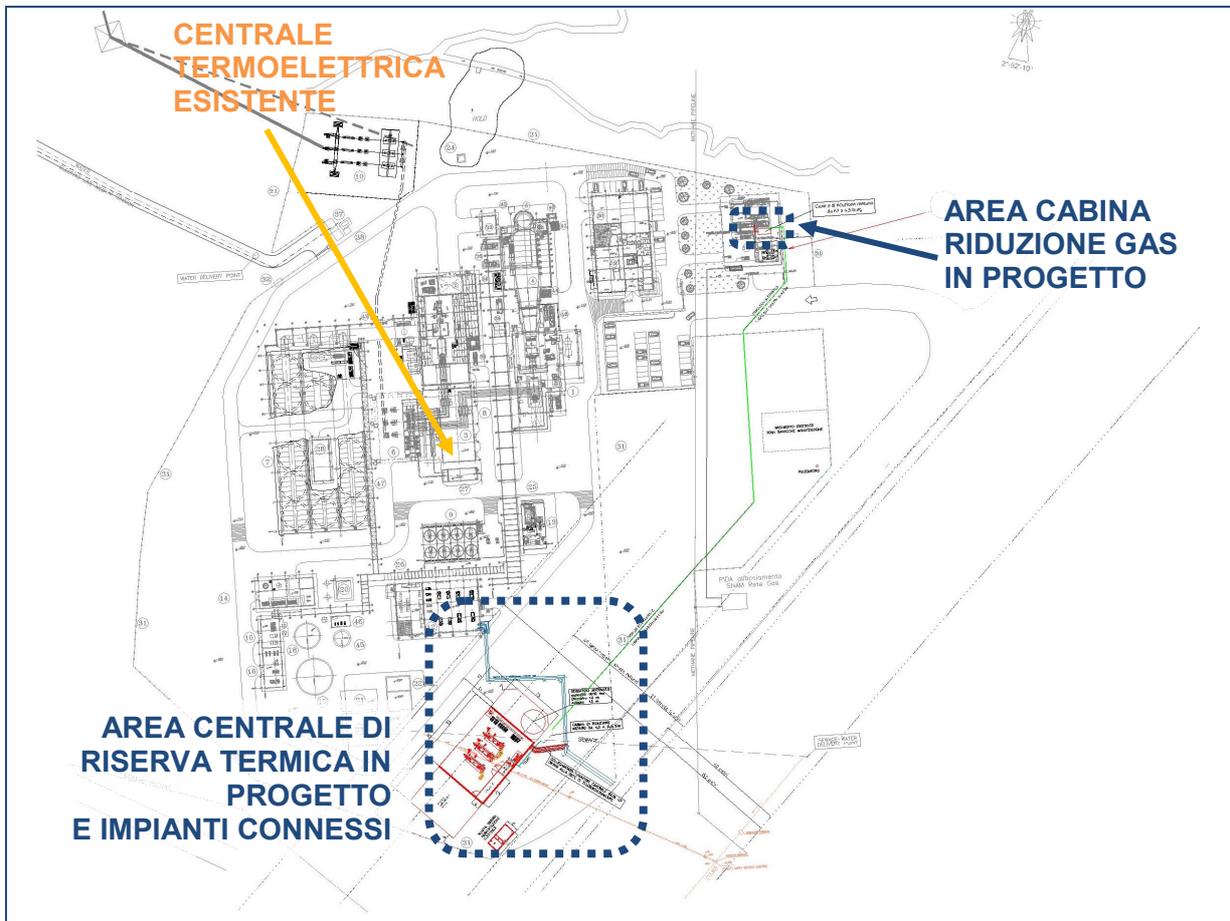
/4 Planimetria di dettaglio della nuova Centrale di Riserva in progetto
